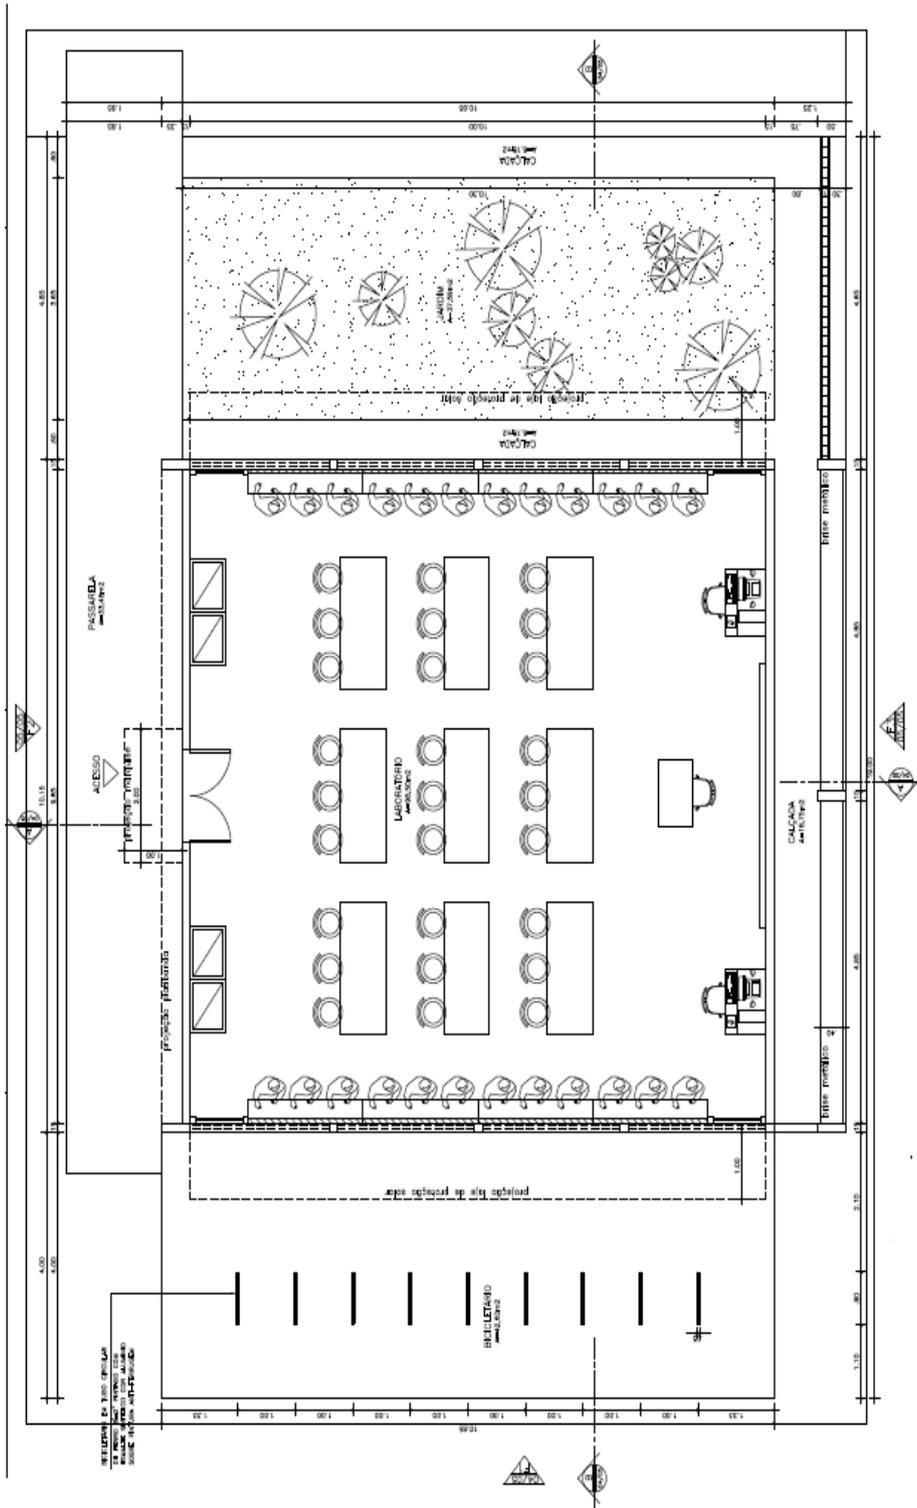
Planta de layout do projeto final do estudo de caso. (Fonte: COP/UFC)
